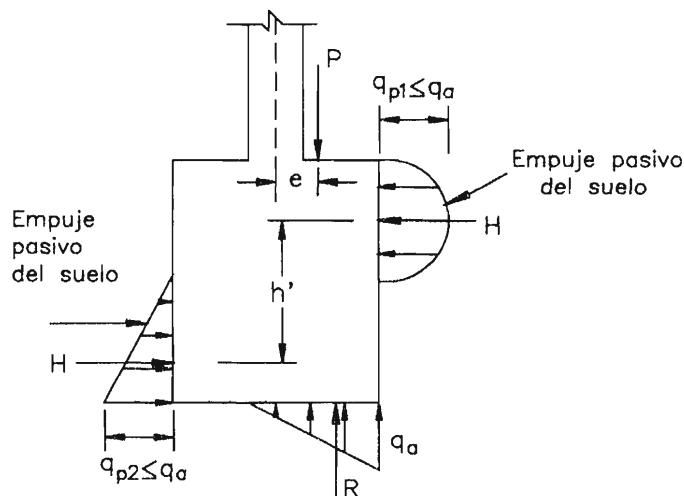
Efecto del empuje pasivo sobre la cimentación
